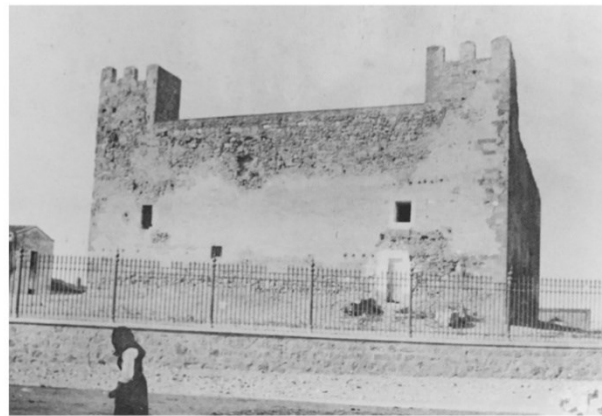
Progetto restauro Ing. Piras (1925)
